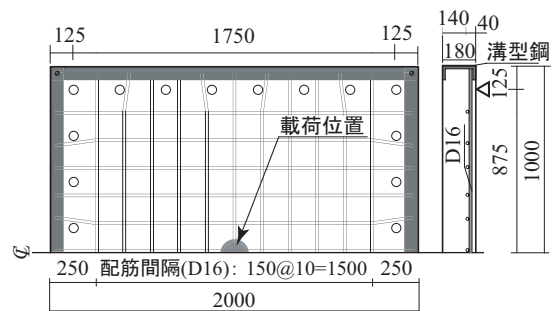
には、試験体の形状寸法、配筋状況および載荷位置を示している。RC 版は 2,000×2,000 mm の正方形形状であり、下端鉄筋の平均芯かぶりが 40 mm となるように配置されている。また、鉄筋は D16 を用いて版中央から 150 mm 間隔で格子状に配筋しており、RC 版の外縁に配置した溝型鋼に溶接定着し、定着長を節約している。
